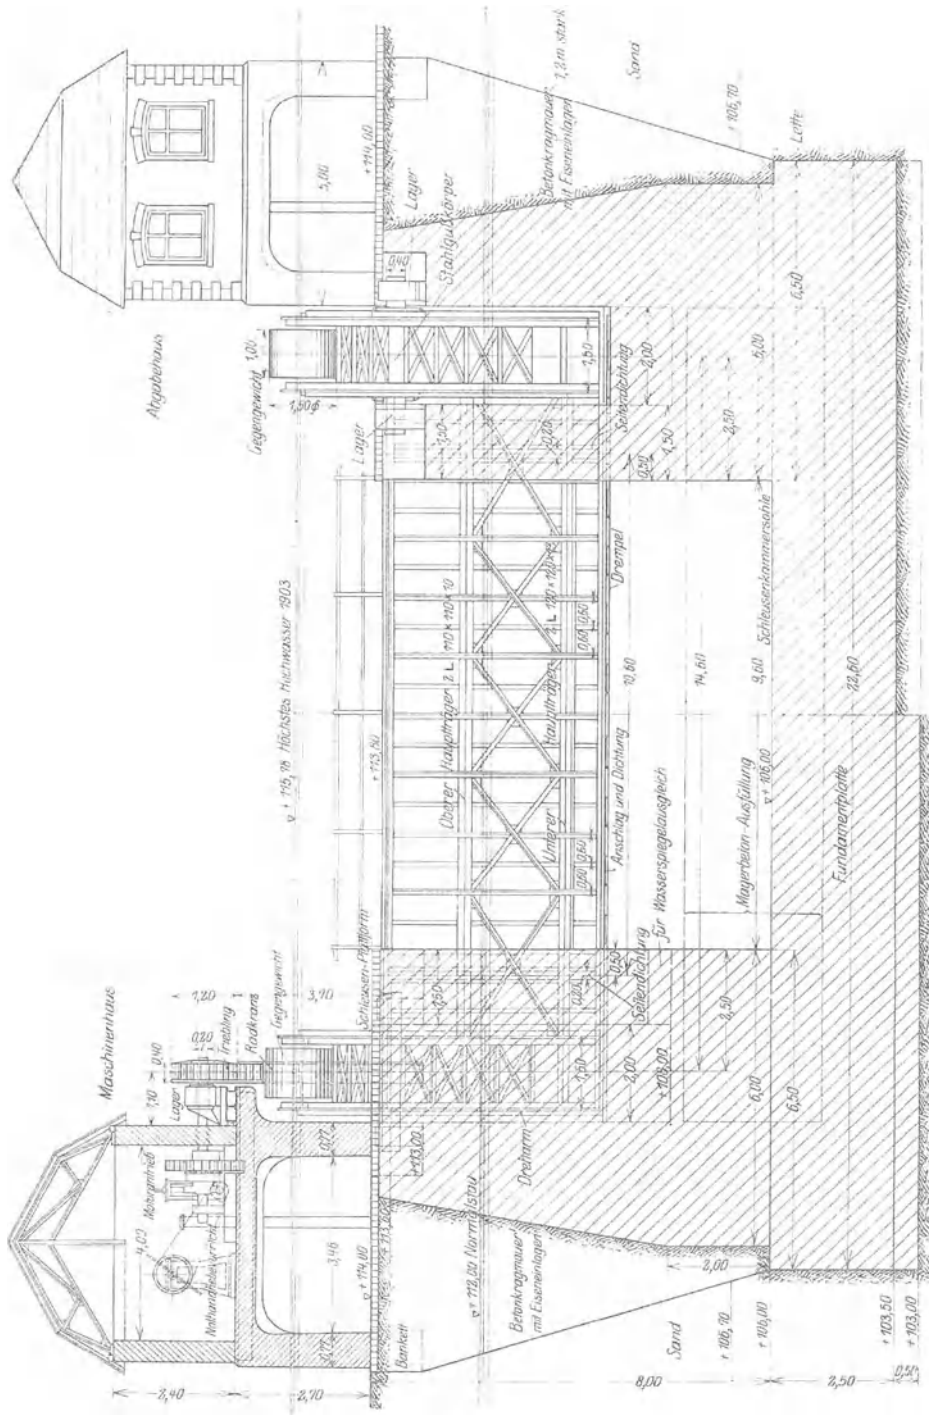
a. Querschnitt des Oberhauptes mit Segmenttor.
